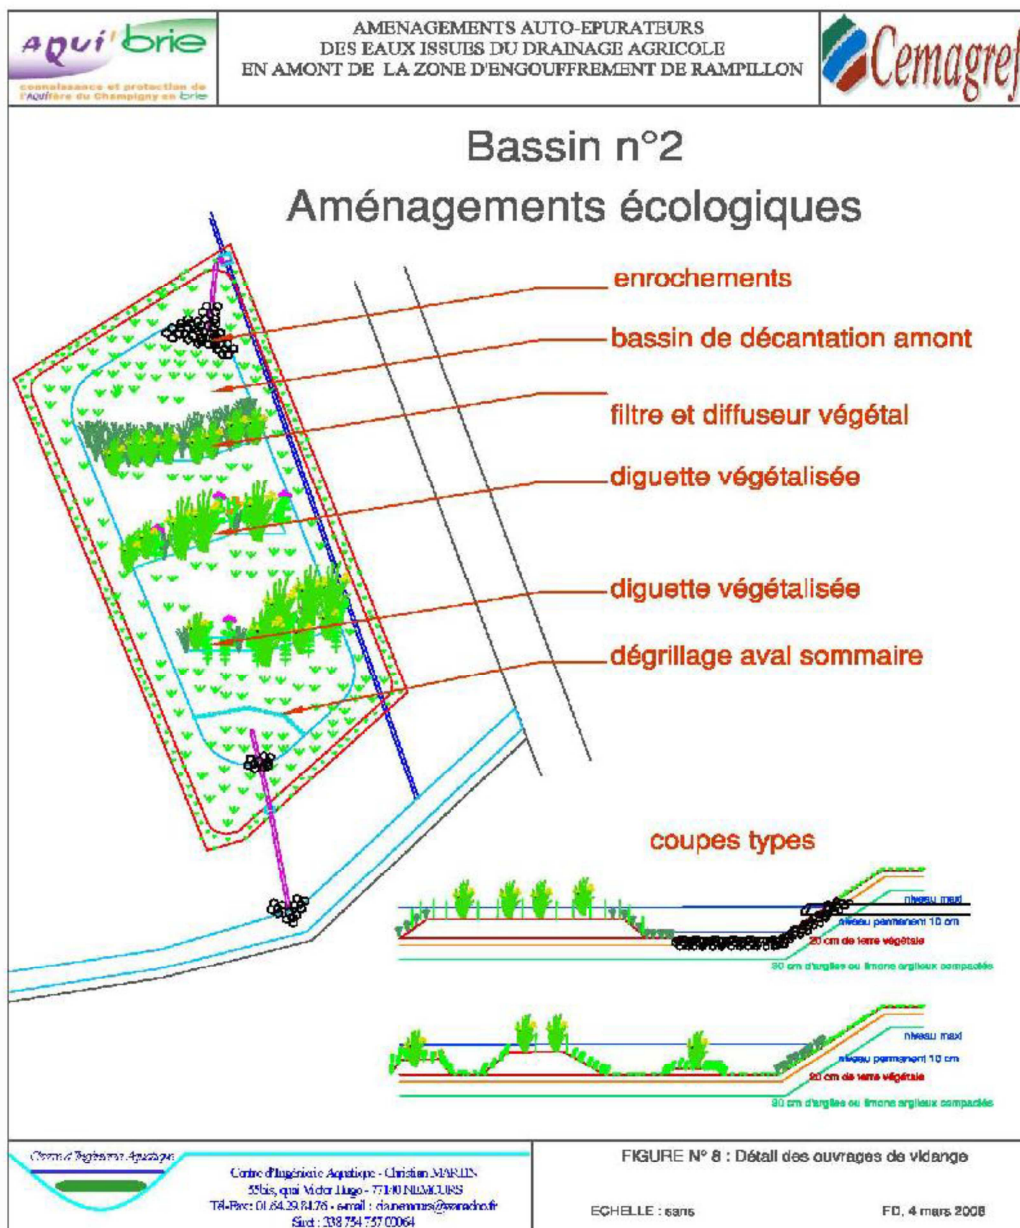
Plan d'une ZTHA projetée (exemple de Rampillon)
